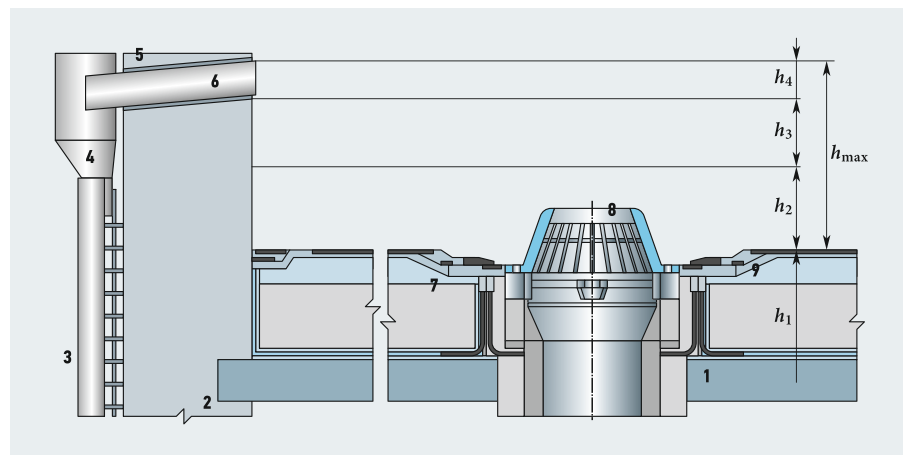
Схема заполнения плоской крыши здания дождевыми осадками [1 — прогон; 2 — наружная стена; 3 — наружный водосток; 4 — водосборный бак; 5 — парапет; 6 — аварийный слив; 7 — кровля; 8 — водоприёмная воронка внутреннего водостока; 9 — крыша (выкопировка из [3]); h_1, h_2, h_3, h_4 и h_{\max} — высоты объёмов дождевой воды: смачивающего поверхности крыши и имеющихся на ней элементов, расчётного для внутренних водостоков, аккумулируемого, аварийного и общего максимального]
